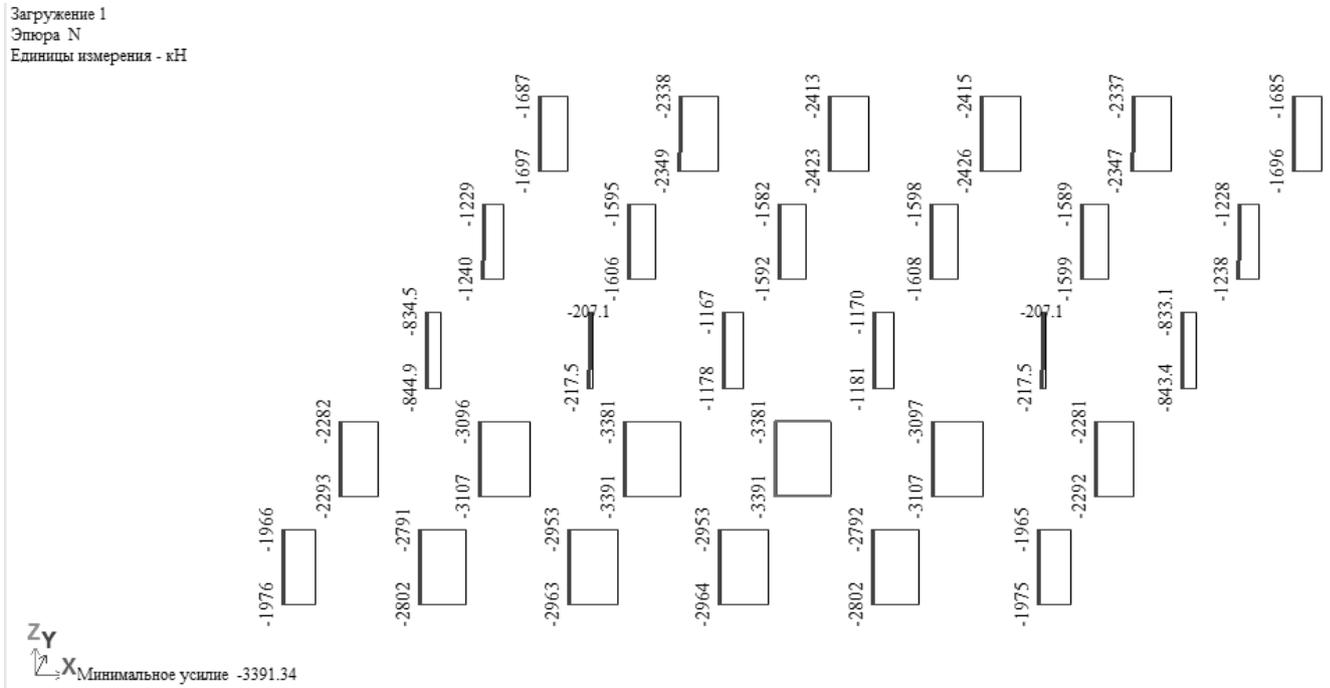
Эпюры N в стержнях колонн типового этажа, кН
